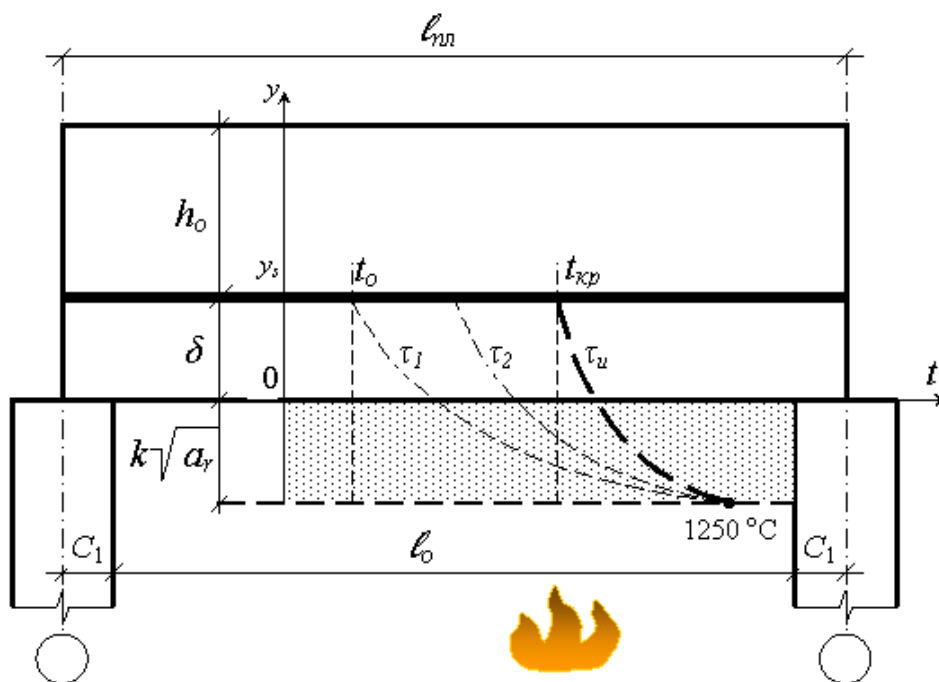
Розрахункова схема нагрівання знизу залізобетонної плити
